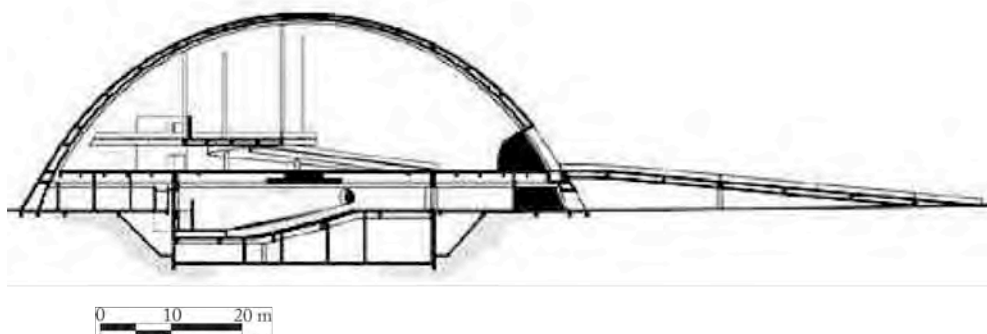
Museu de Brasília (2006) – versão construída – corte – rampa reta.
